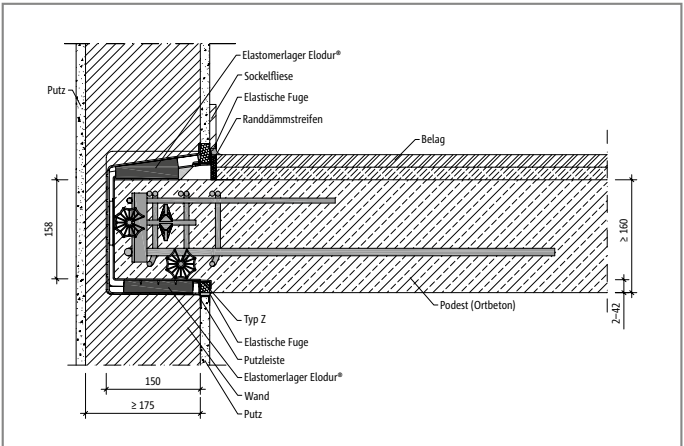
Schöck Tronsole® Typ Z-V+V-T: Einbausschnitt Ortbetonpodest
